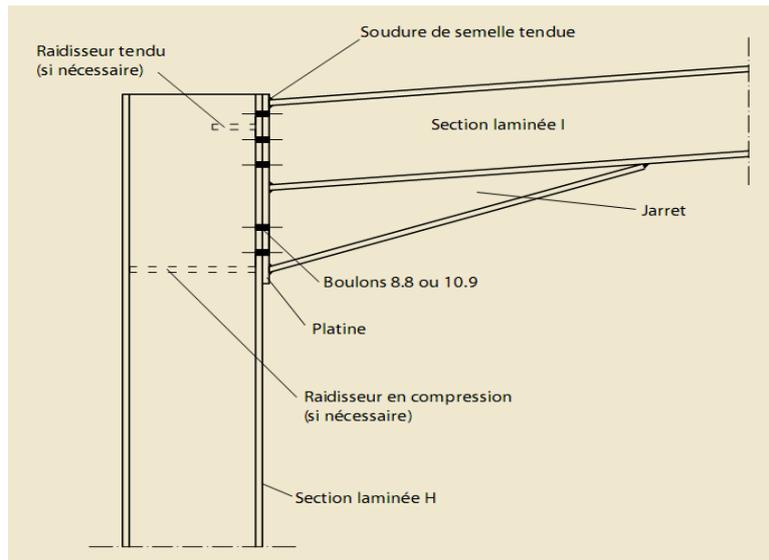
Assemblages poteaux-poutres typiques dans un portique
